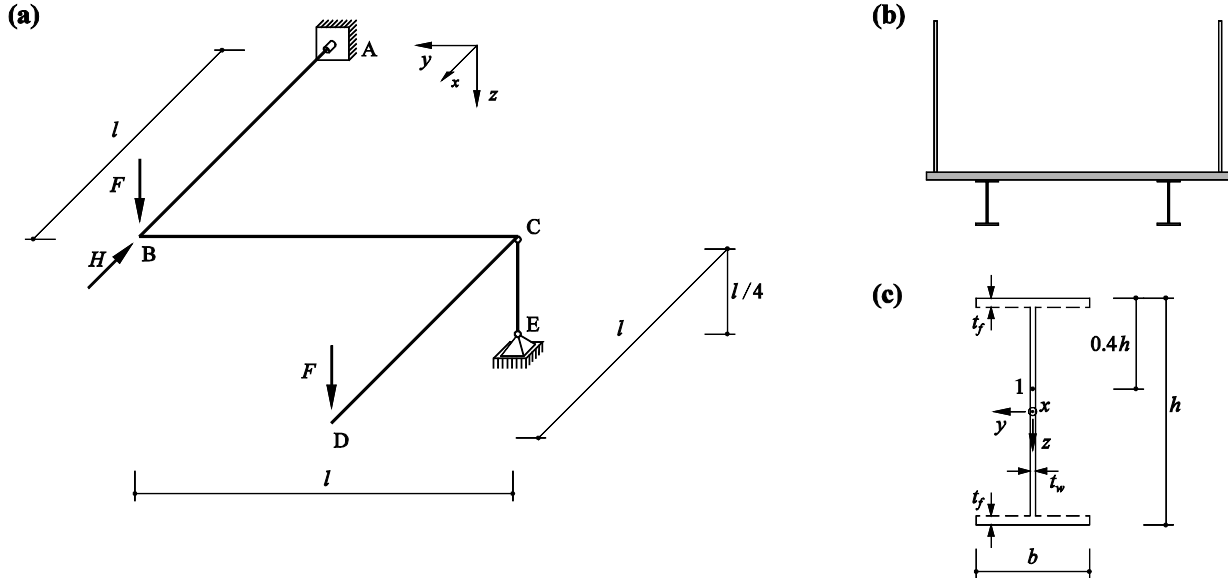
Räumliches Stabtragwerk: (a) Perspektive; (b) Querschnitt; (c) Profilabmessungen.
